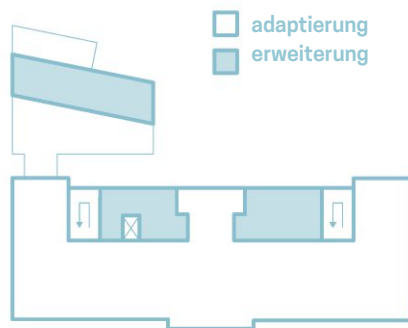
Schema Bestand: Grundriss 2. Obergeschoß.
